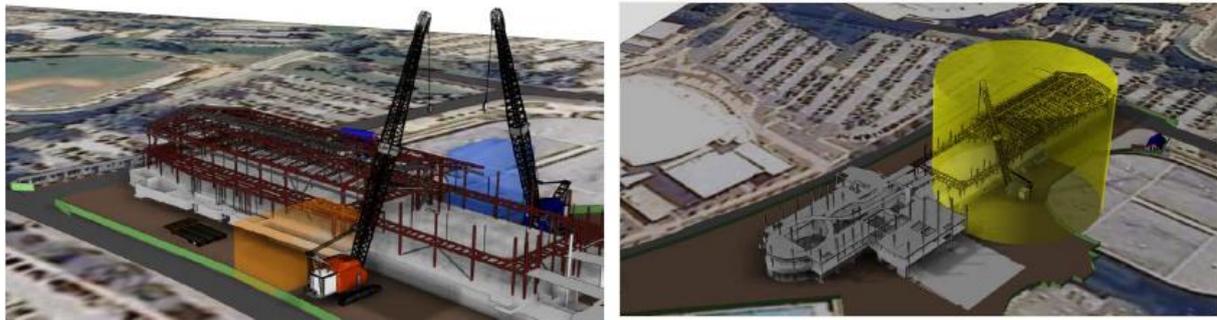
Colocação da armação de aço e zona de trabalho da grua no plano de gestão de guindastes [26]
